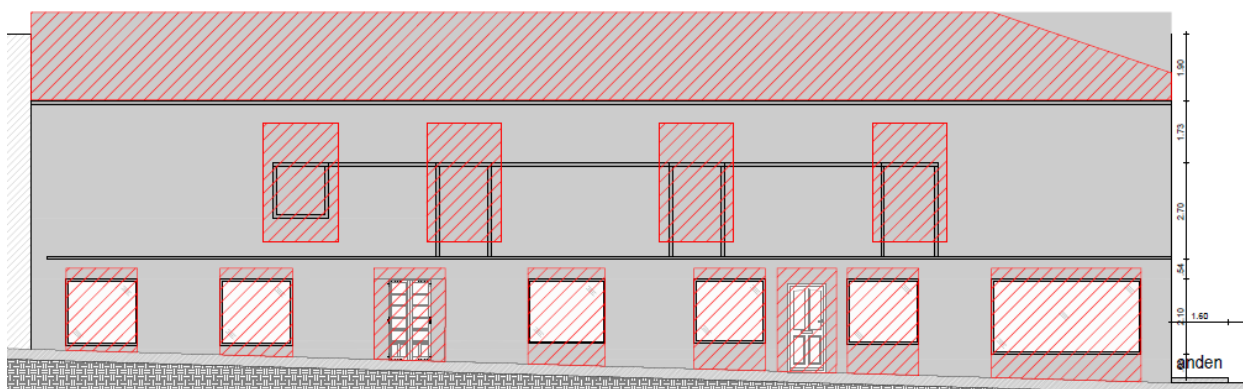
Fachada carrera 21 a. Fuente: Propia
